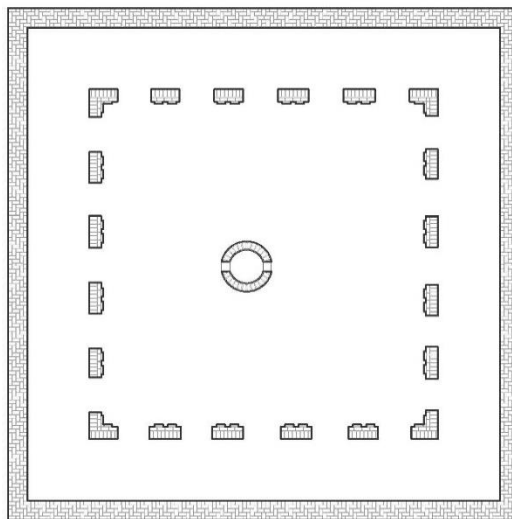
Planta común de un claustro (Alejandro Serra 2016).
